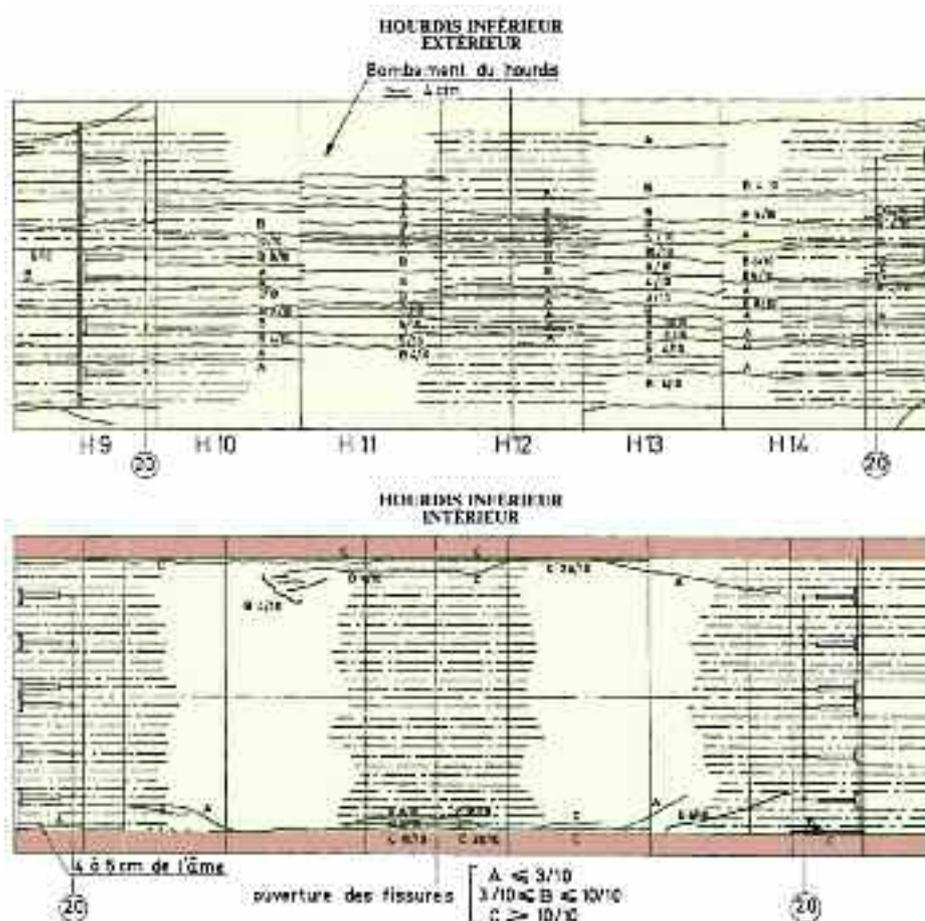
schéma de fissuration du hourdis inférieur du pont de Bussang dans la zone de clé
